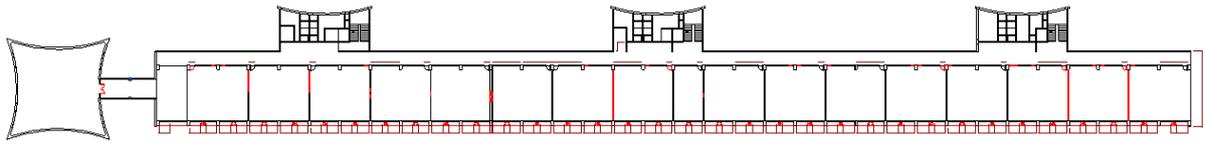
Vista (segundo pavimento) do resultado do projeto. Fonte: Autores.
